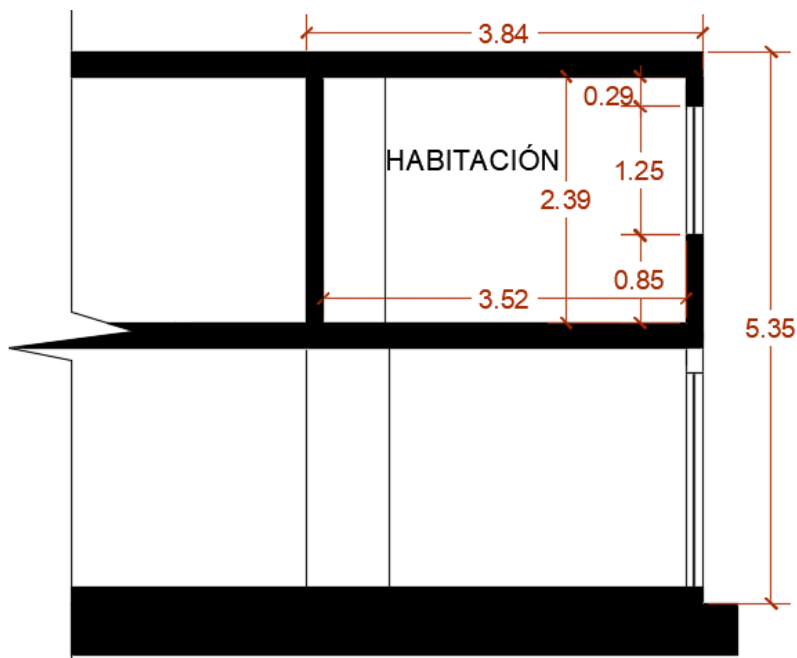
Corte arquitectónico. Fuente: Elaboración propia del autor.
